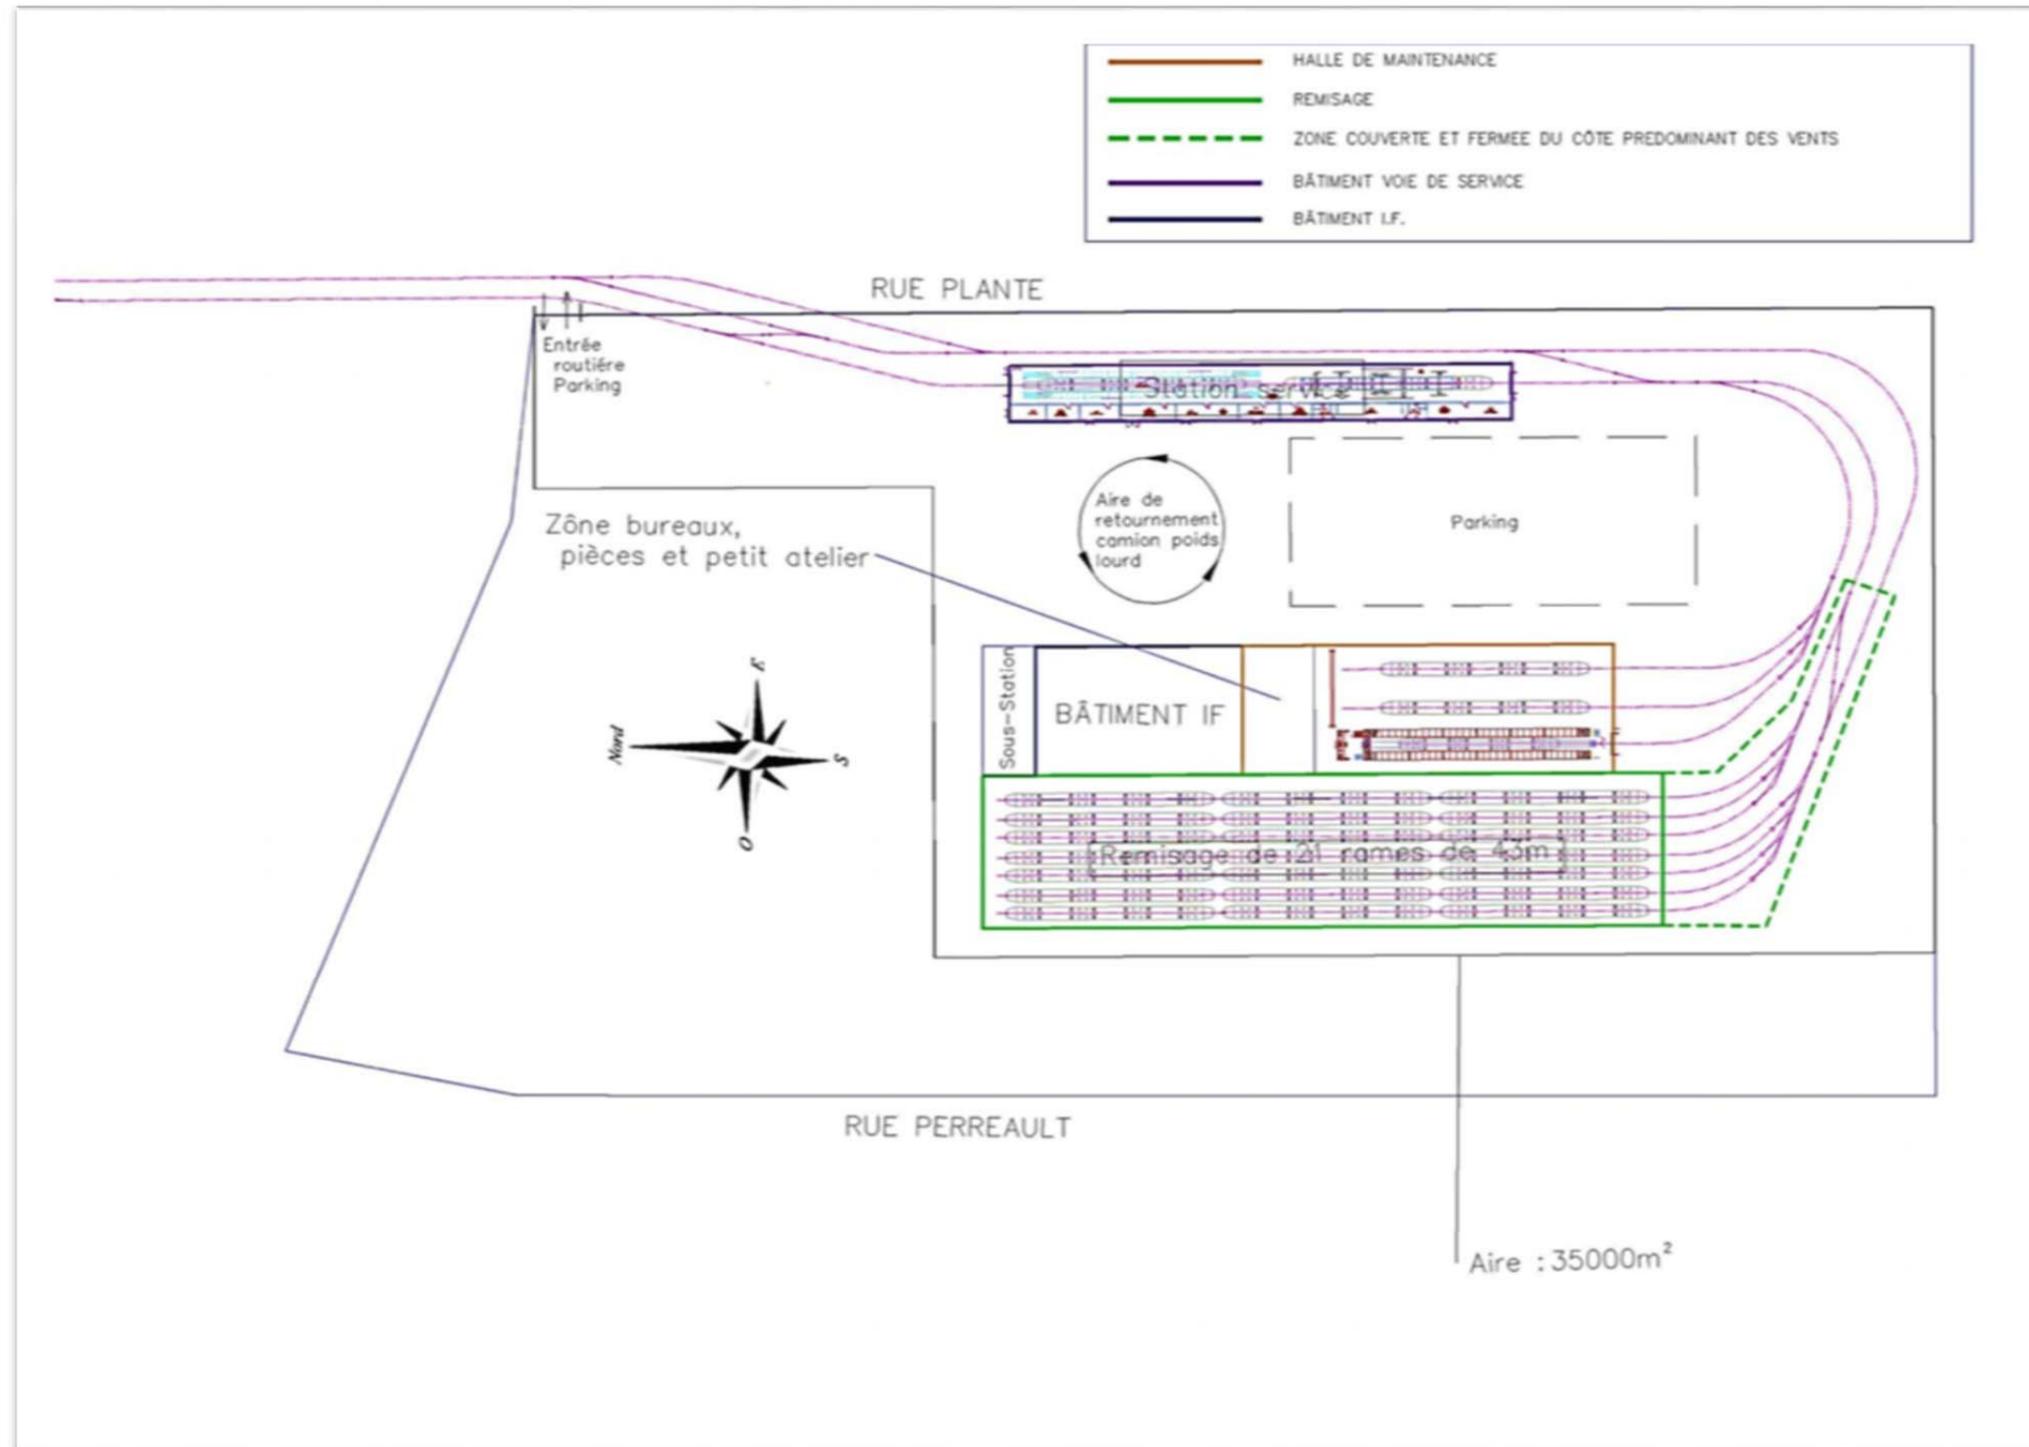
Plan masse CEE Secondaire - rue Plante, Lévis
